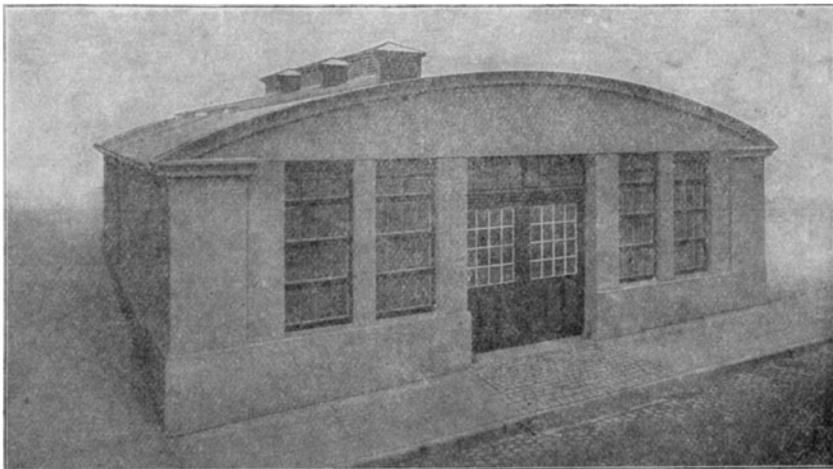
Wagenhalle mit Parabel-Fachwerkbinder.
